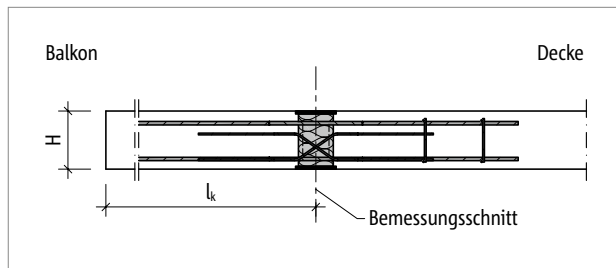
Schöck Isokorb® XT Typ DP: Statisches System
